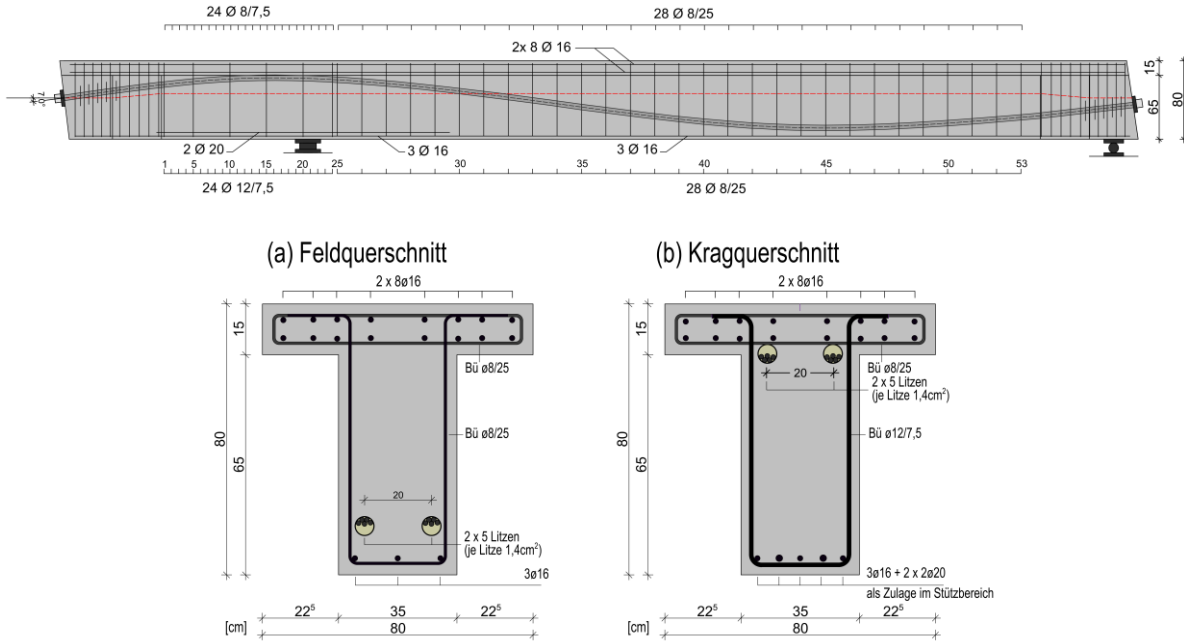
Bewehrungsplan Versuchsträger ETK1
